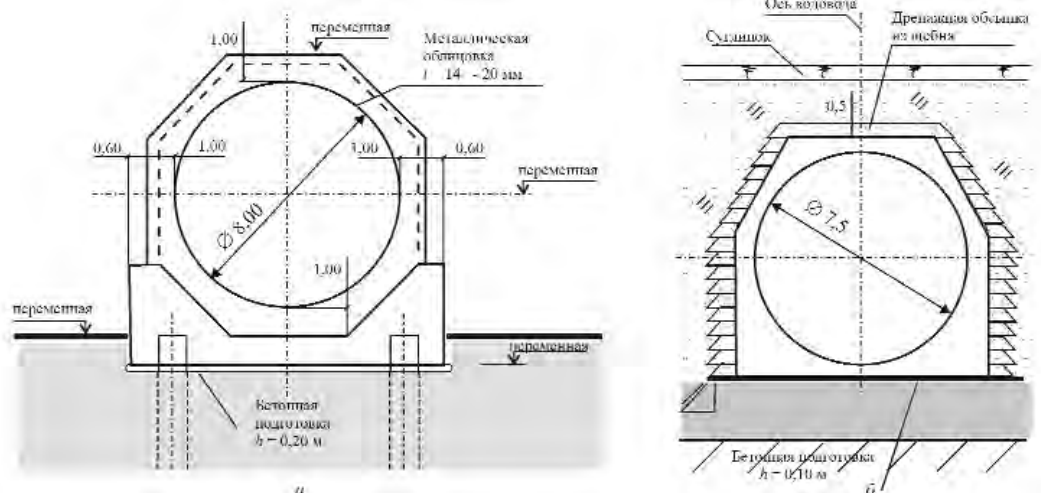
Поперечные сечения сталежелезобетонных водоводов Каневской (а) и Ленинградской (б) ГАЭС
